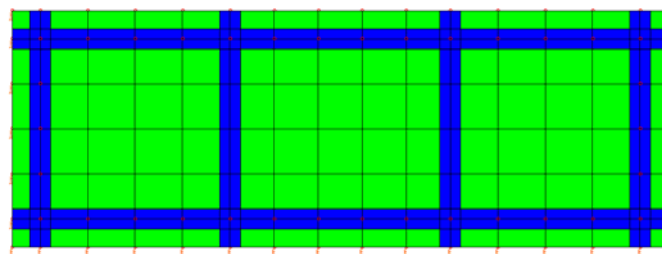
Vista in Pianta Platea e Travi di Fondazione
